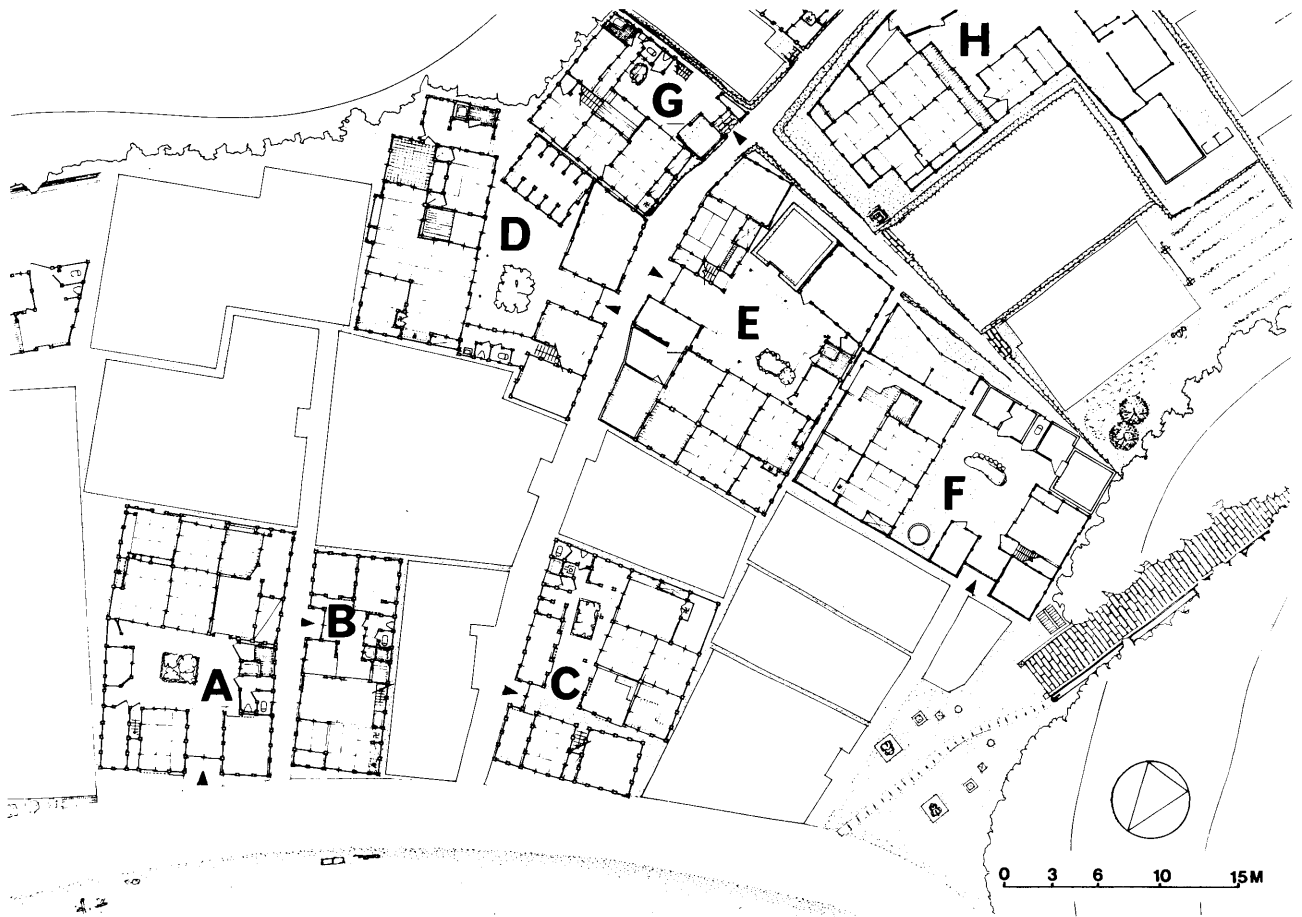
二神島 小泊の民家 配置図・平面図 (A・C・D・E・Fは中庭形式とでも呼ぶべき配置をよく示している。黒三角印は2階建のへやと呼ばれる建物の1階にあげられた門)
